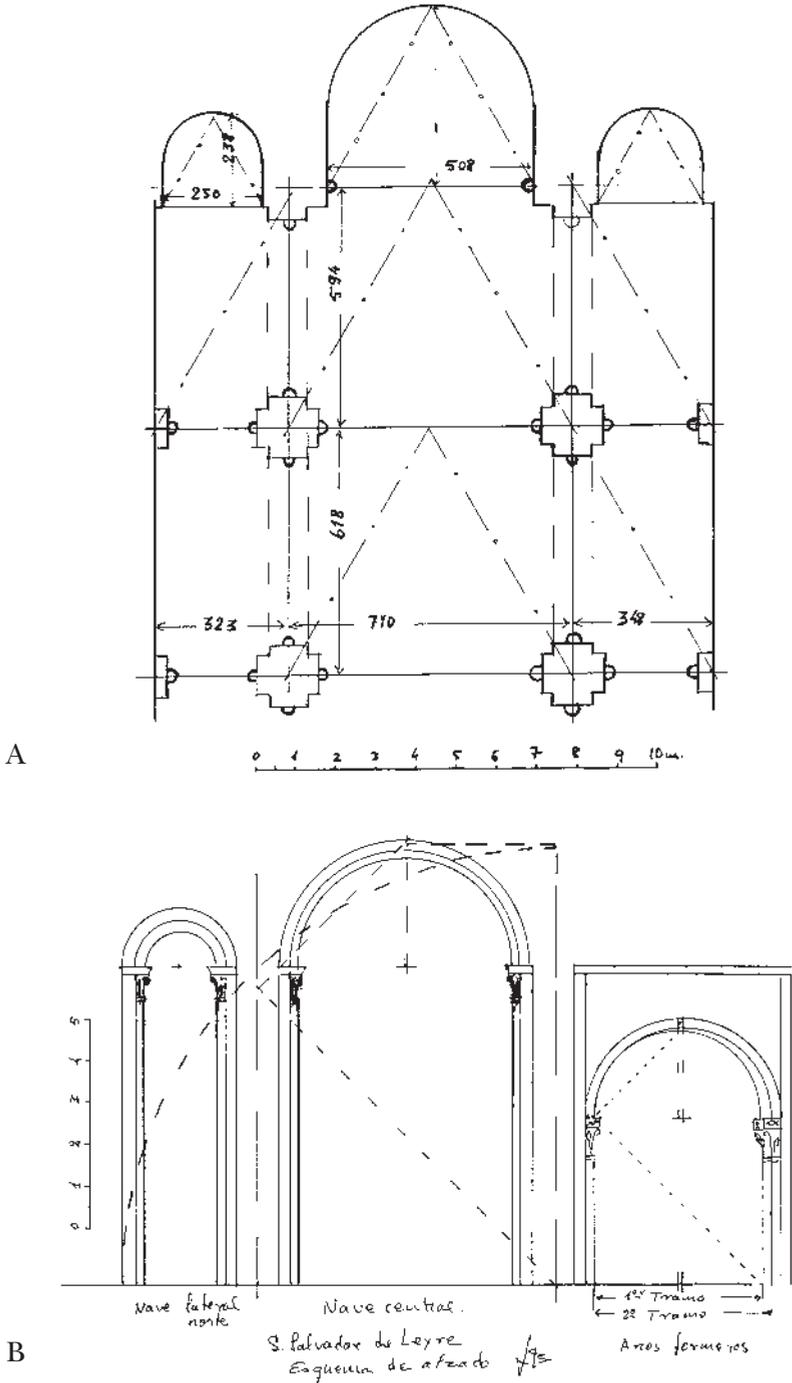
A: Planta de San Salvador de Leyre. B: Alzados de la iglesia.
